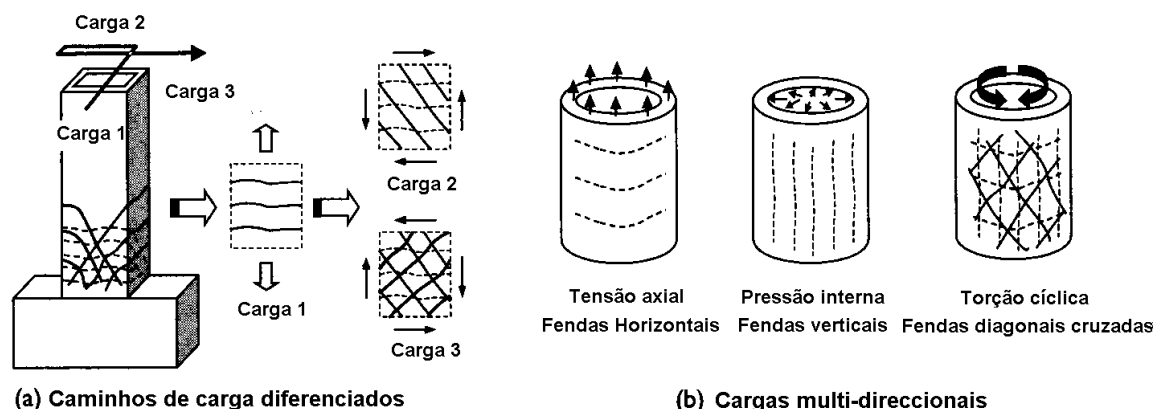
Exemplos de fissuras não ortogonais em elementos estruturais. Adaptado de (Maekawa et al. 2003)
